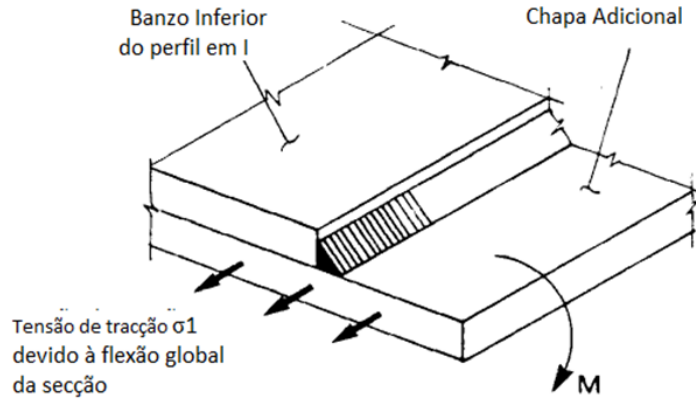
Pormenor do banzo inferior da viga SFB [23].
